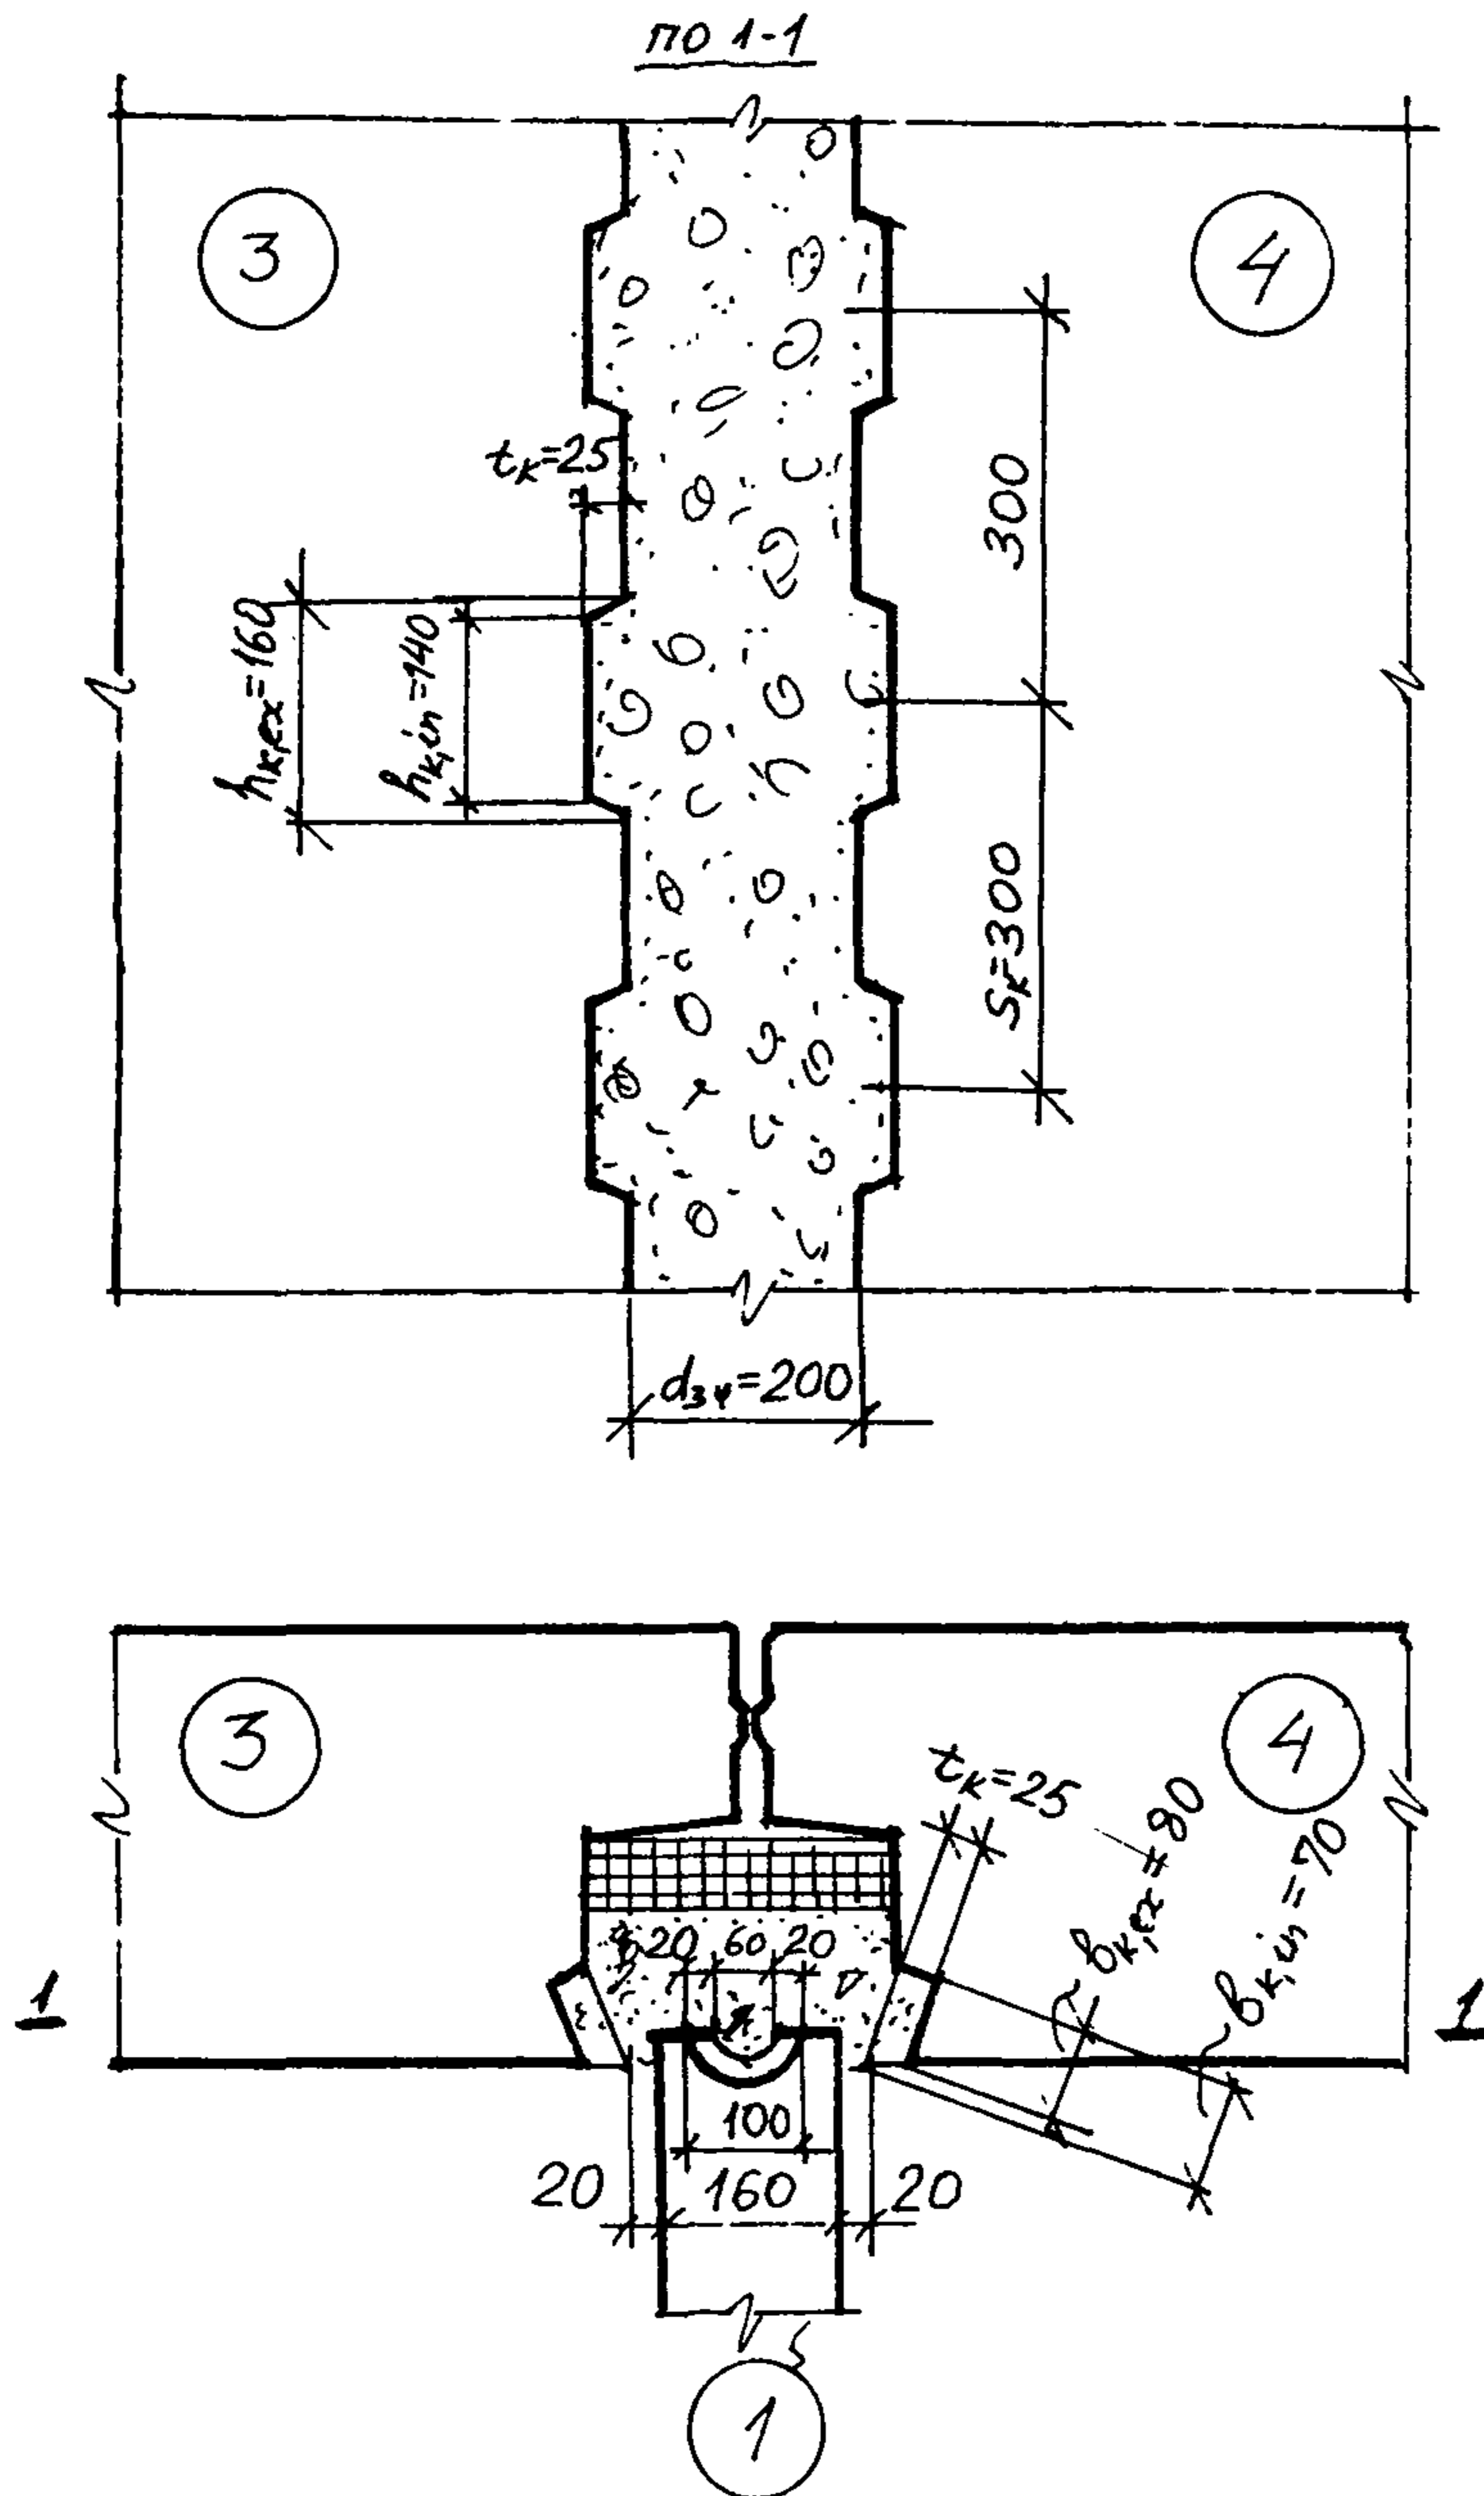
Вертикальный стык наружных стеновых панелей с внутренней стеной (к примеру 10)
